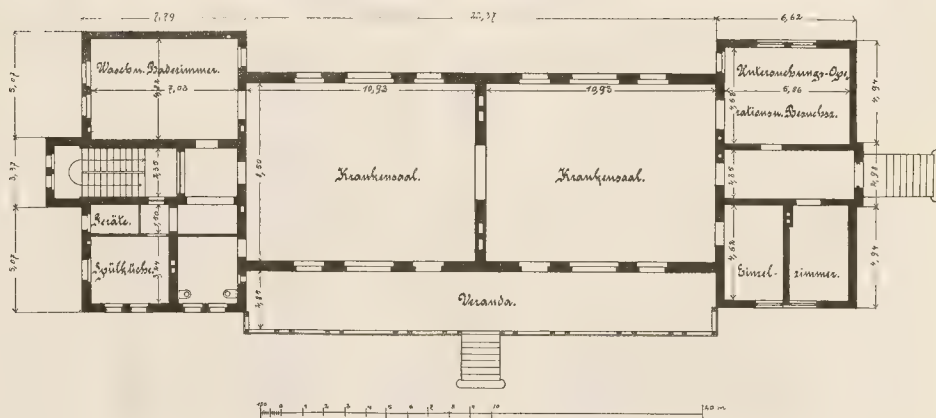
Gebäude 5 und 6; Grundriss.
